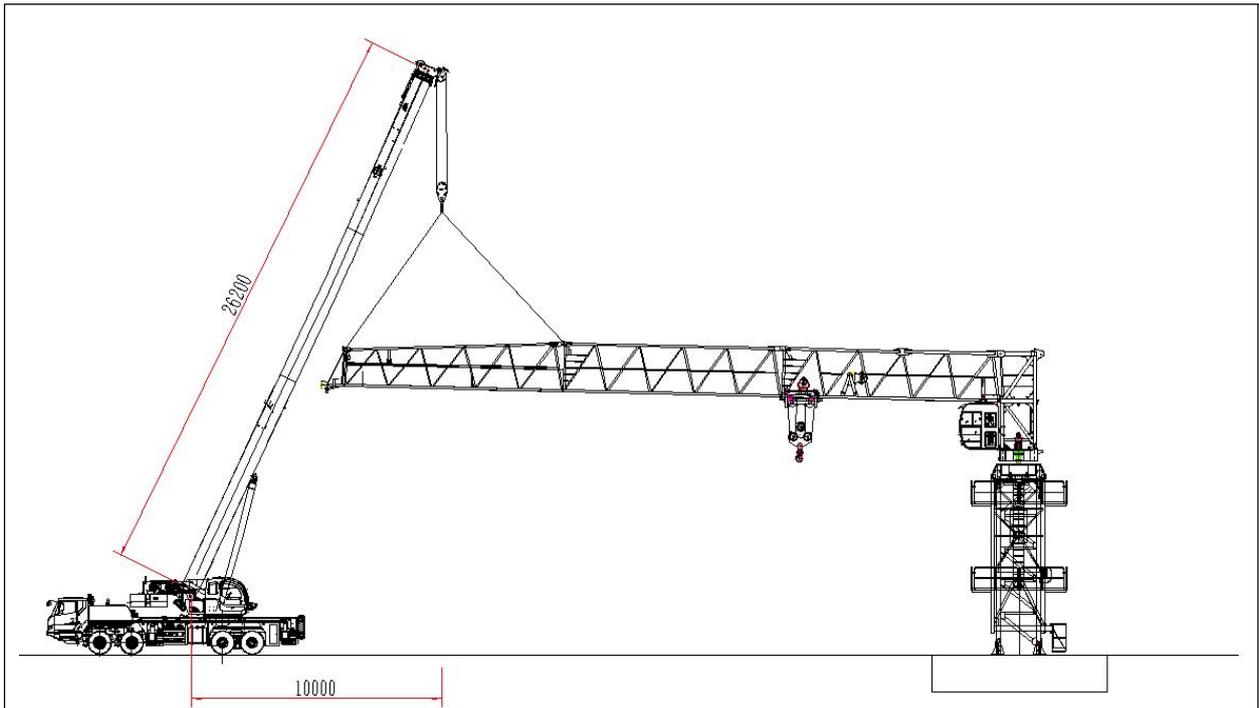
起重臂臂节三拆除立面图（单位：mm）
